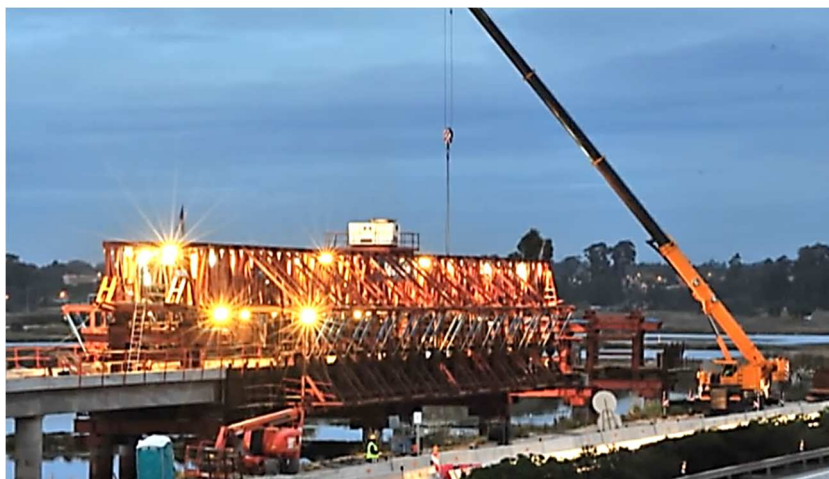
Processo construtivo para execução da estrutura do viaduto (REFER, 2010).
